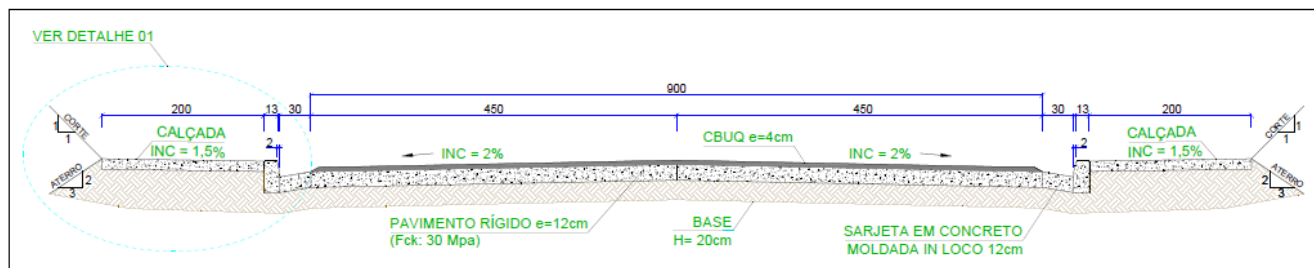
EXEMPLO DO TIPO DE SEÇÃO TRANSVERSAL DO PAVIMENTO
